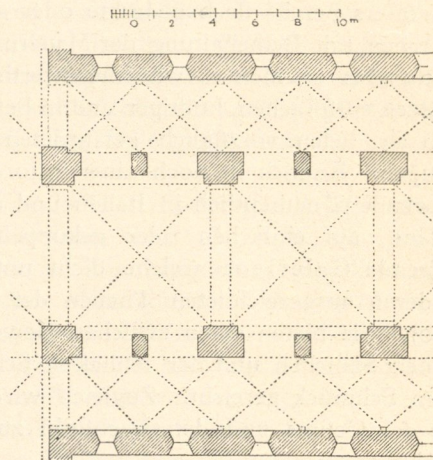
Kirche zu Lippoldsberg. Grundriss.
